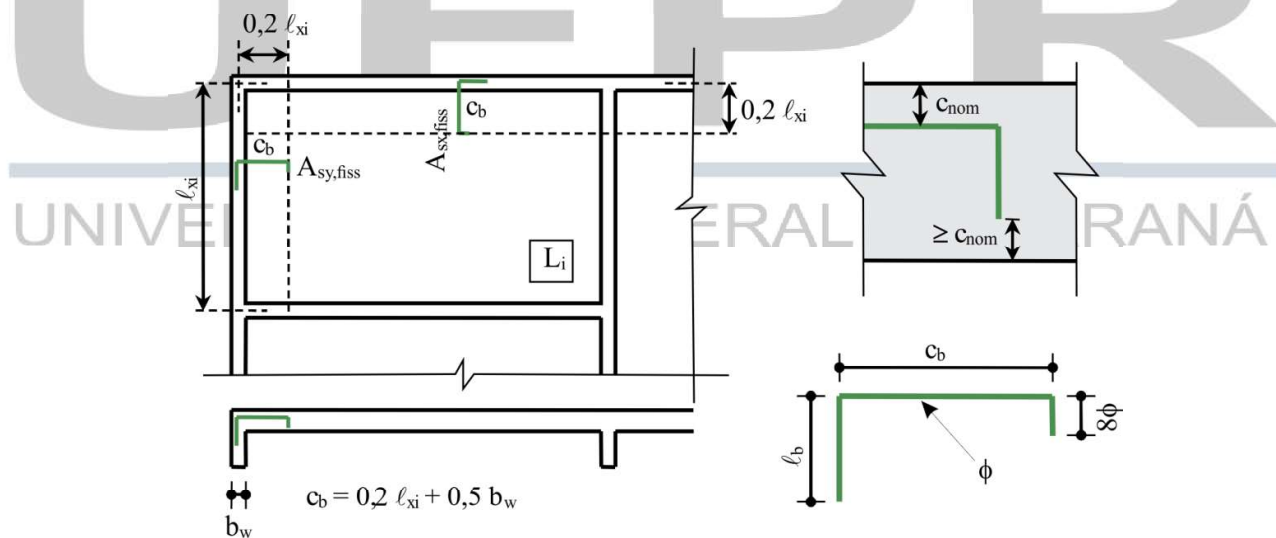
Vigas de contorno – armadura de fissuração
